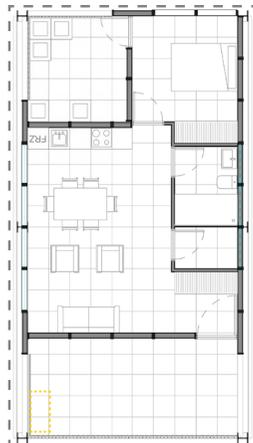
Plantas de ubicación de residuos en tipologías B
